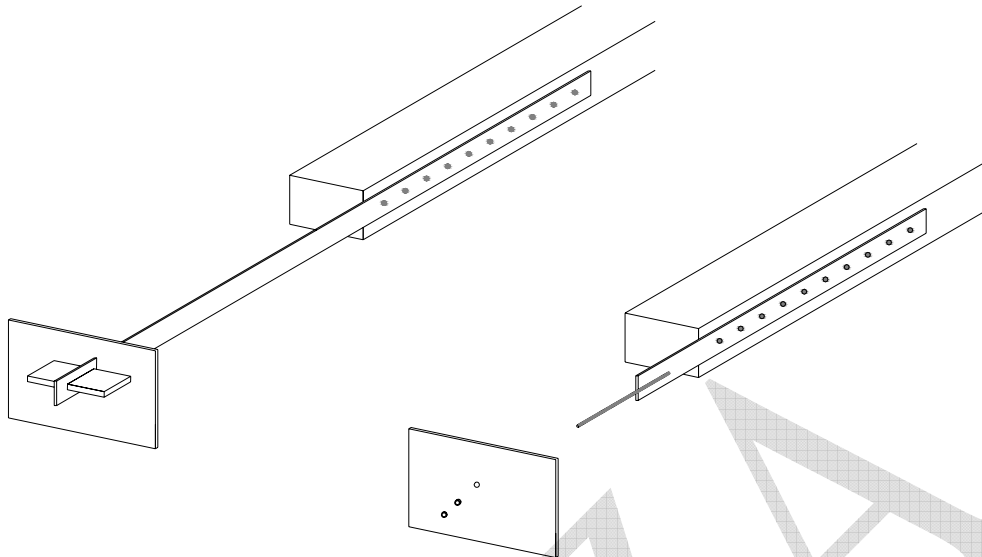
Vista assonometrica di particolare di lama di ancoraggio di trave in legno con muratura
